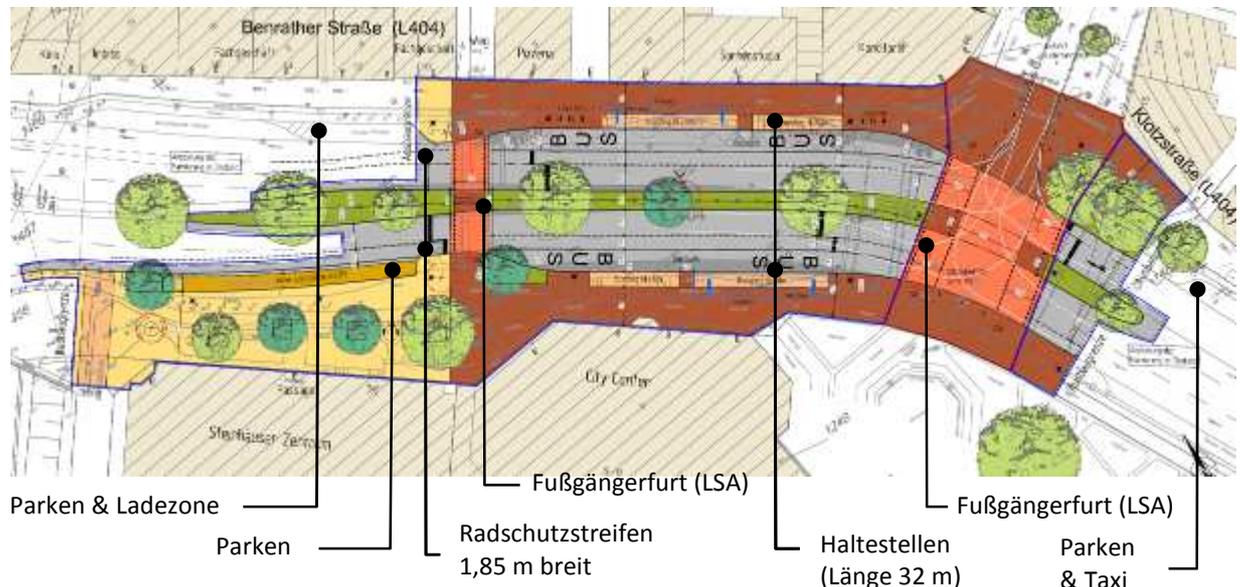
Ausschnitt aus der Planung Variante 1
